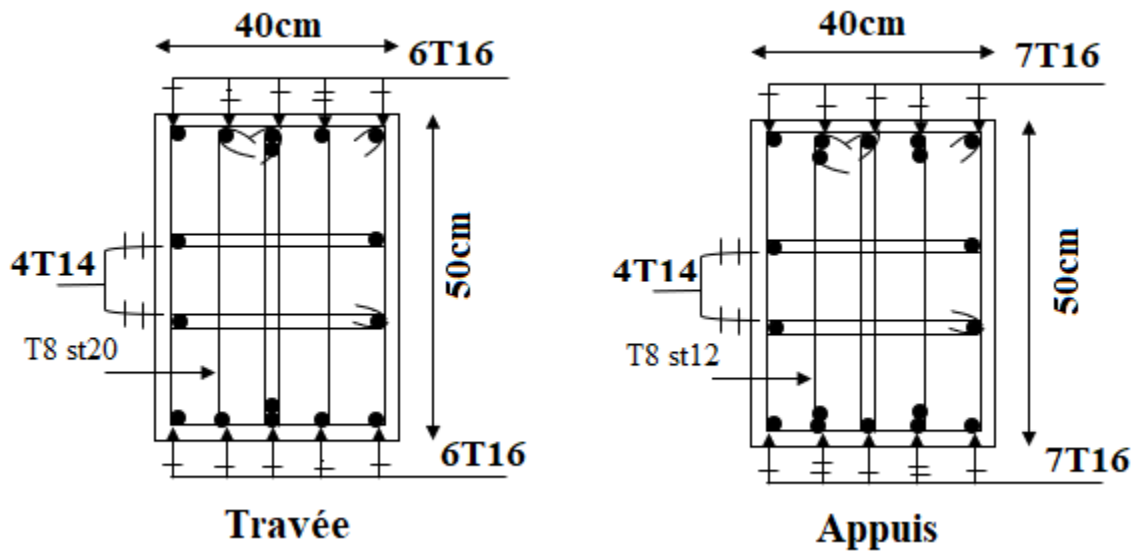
Ferraillage des poutres porteuse (40x50) cm²
